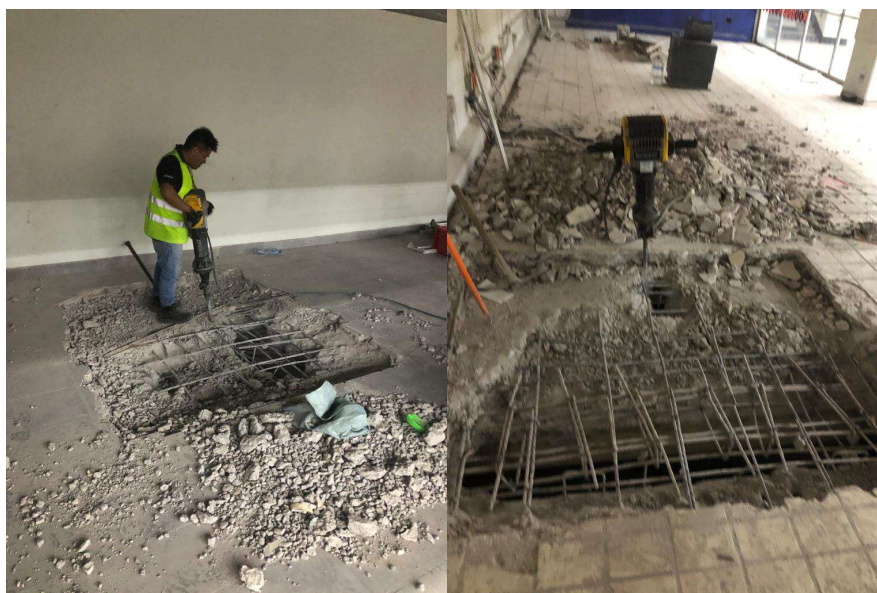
Demolición de losas de concreto. Elaborado por el autor.
